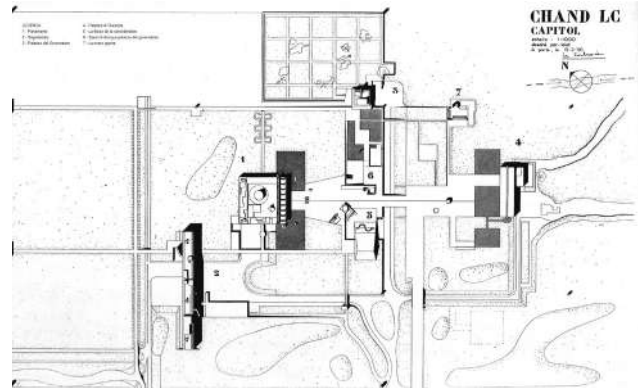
, Chandigar, planimetria di progetto del Campidoglio.
